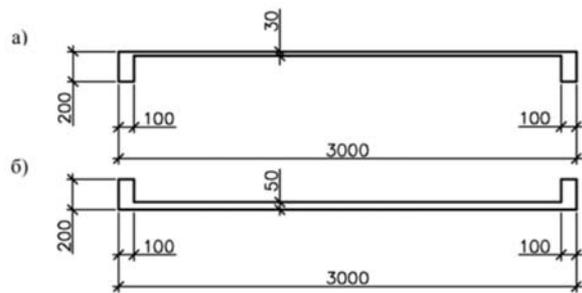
Сечение железобетонных плит пространственной фундаментной платформы: а) верхняя плита; б) нижняя плита
